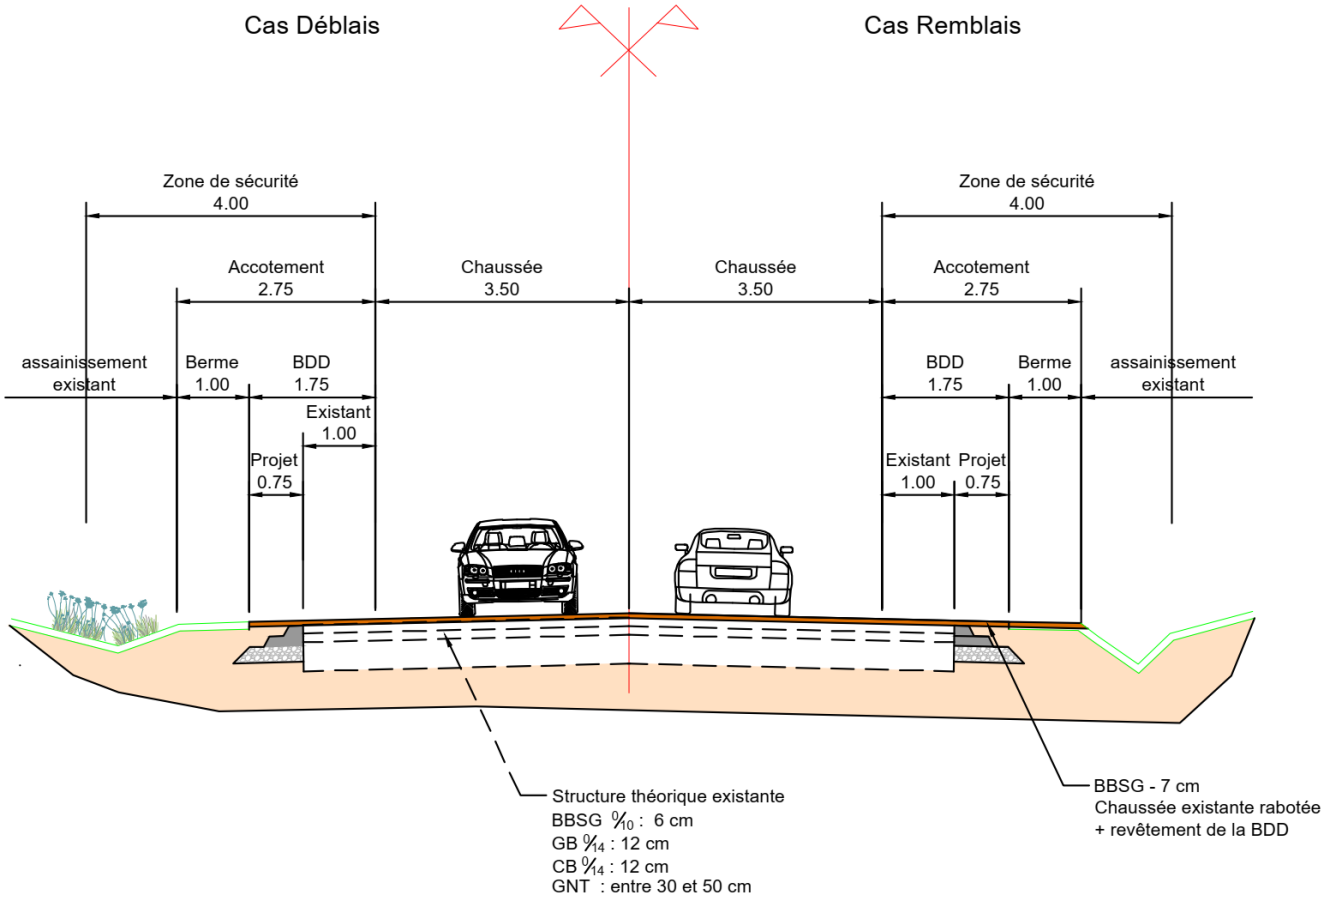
PT AU DROIT DU RÉAMÉNAGEMENT SUR PLACE DE LA RD31 (SOURCE : EGIS)
